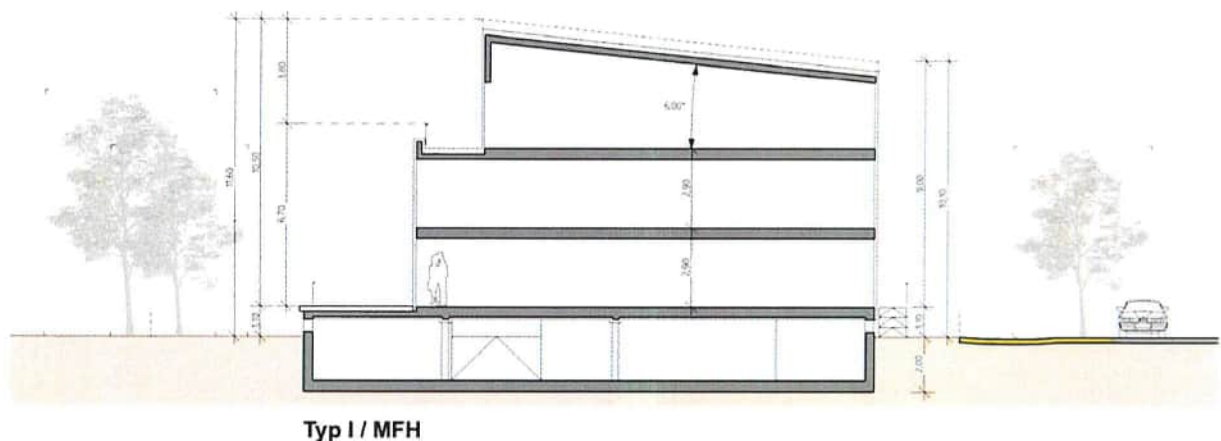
Schemaschnitt Typ I mit teilweise eingegrabener Tiefgarage
